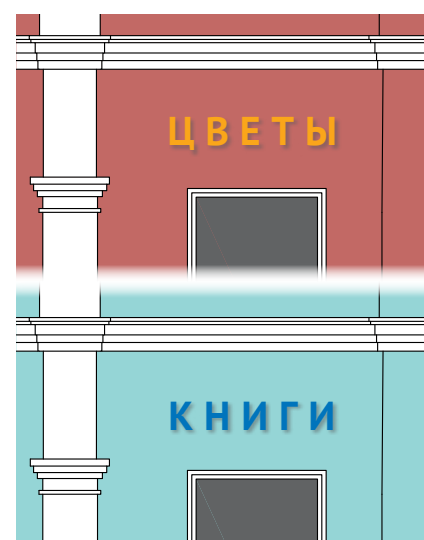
Хорошо: цветные буквы в гамме фасада здания
